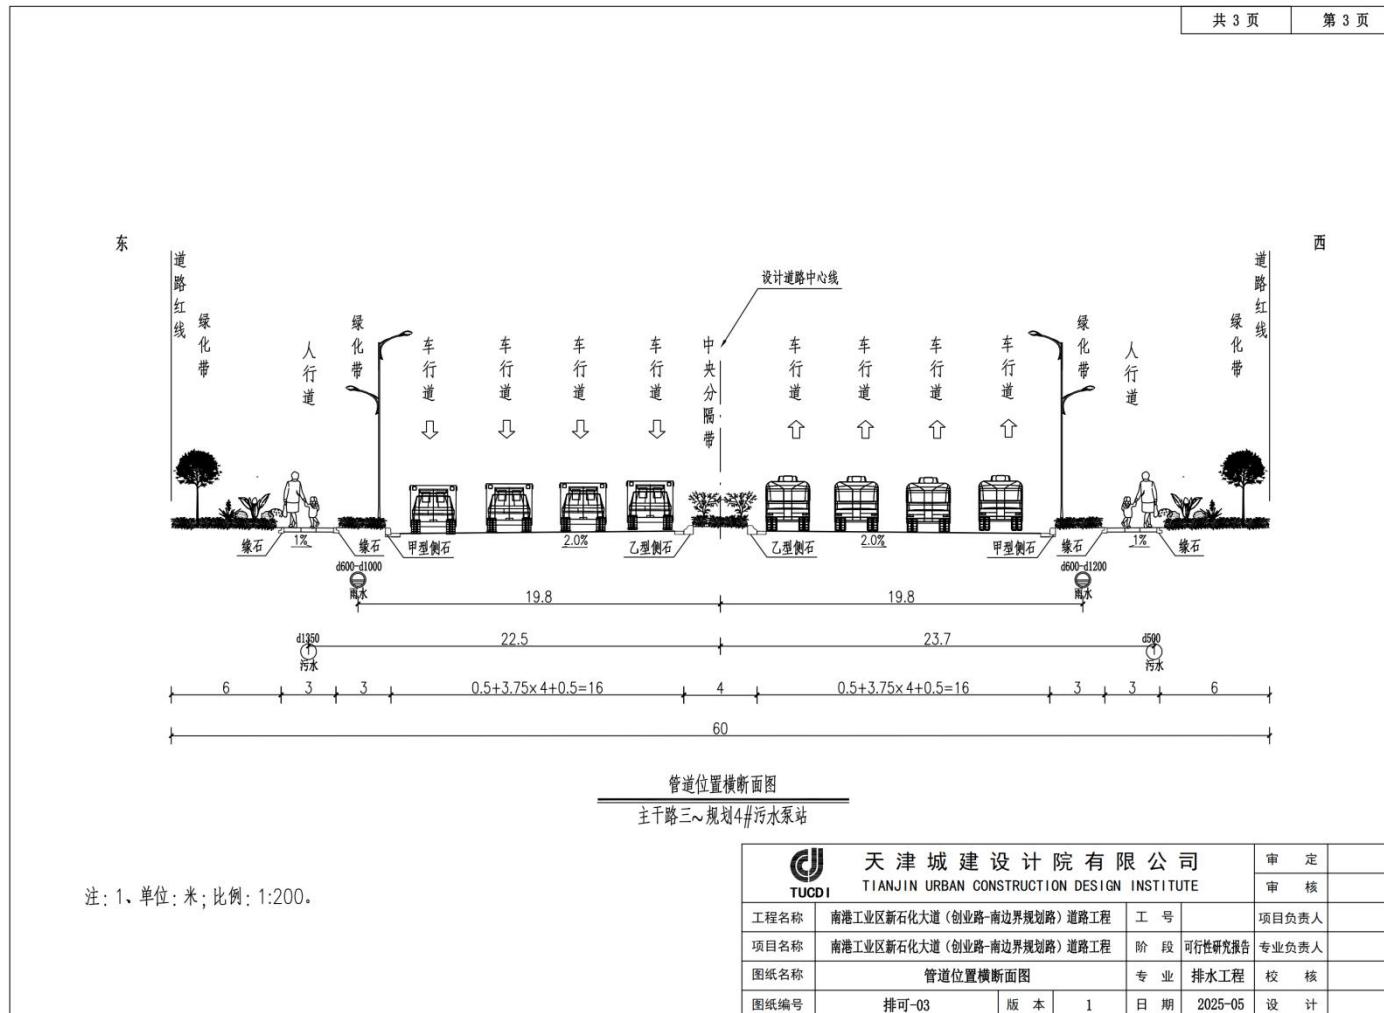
主干路三~规划 4#污水泵站段雨水、污水排放管道工程断面图
